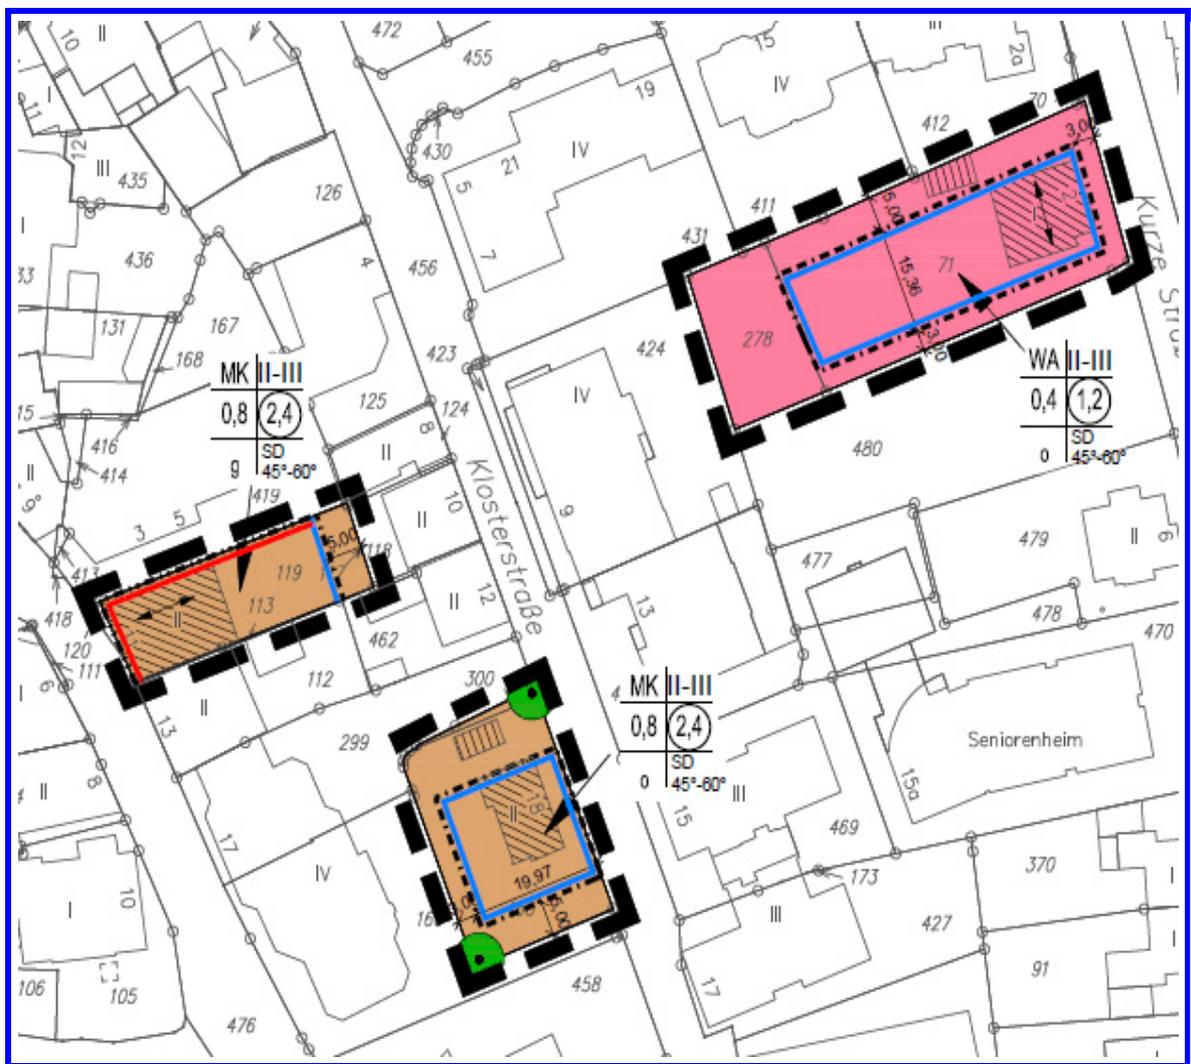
3. Änderungsbereich des B-Plans Nr. 106 (STADT IBBENBÜREN 2021)
